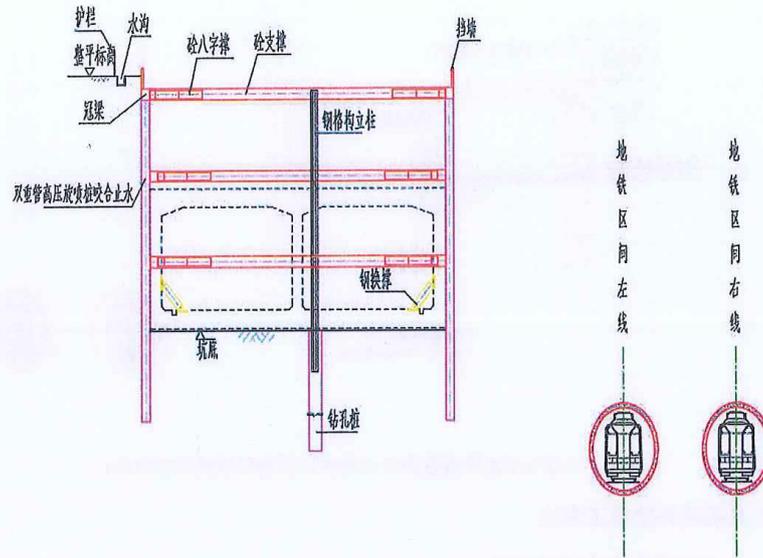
基坑横断面图（地铁 6 号线中山大学站入口段）
